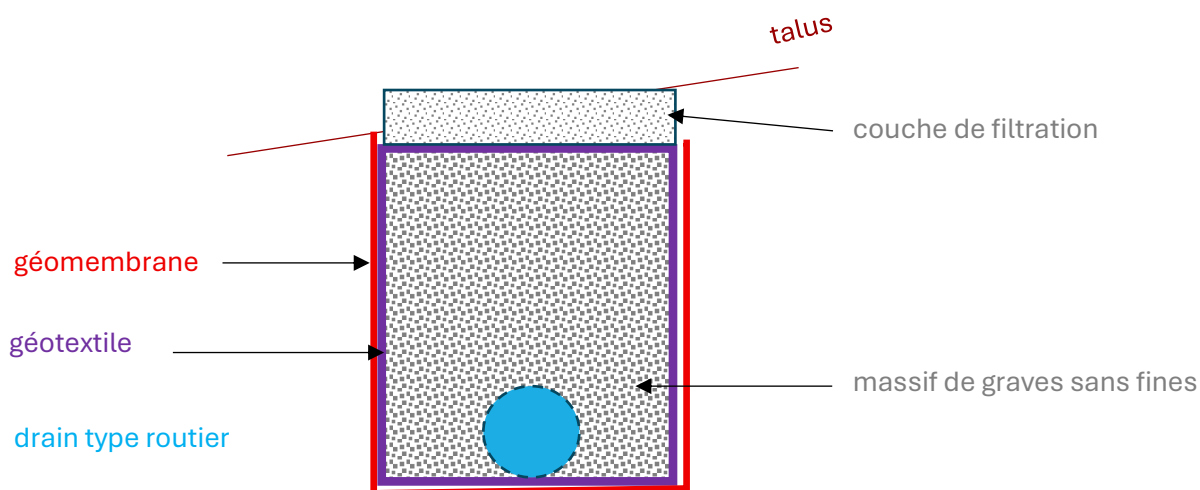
coupe de principe d'une tranchée et d'un épi drainant
